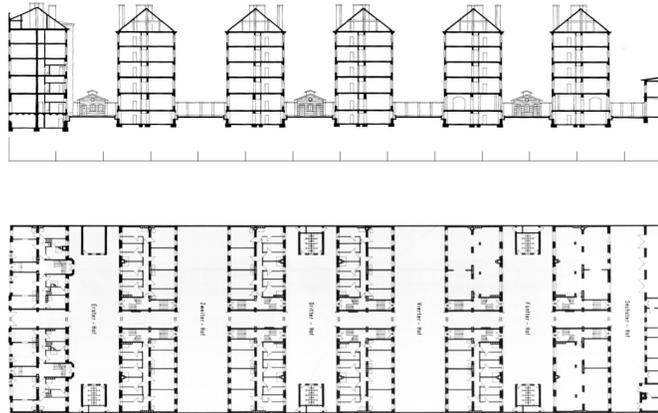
Meyer's Hof, 1875 Grundriss und Schnitt
